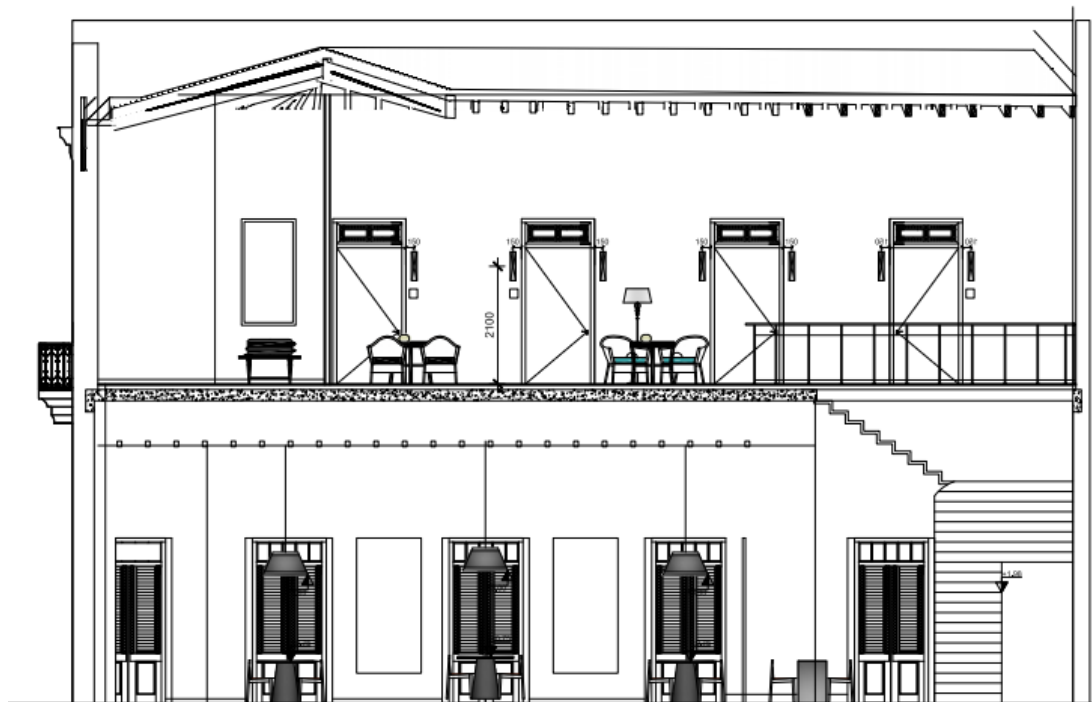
Corte Longitudinal de Acabado. Propuesta
